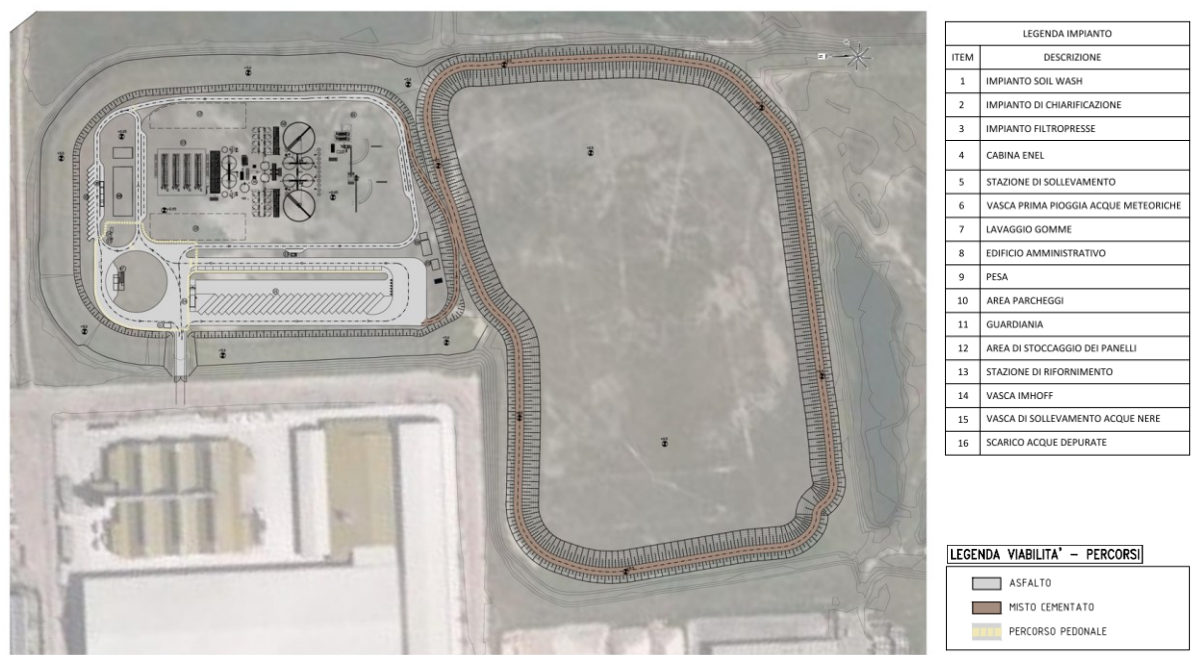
Planimetria di progetto previsto per la Piallassa dei Piomboni
